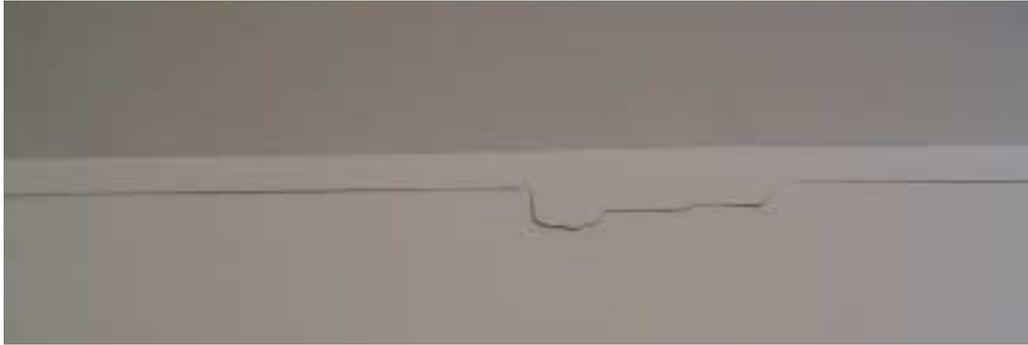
Trinca horizontal na alvenaria de bloco de concreto celular na sua interface com a laje
